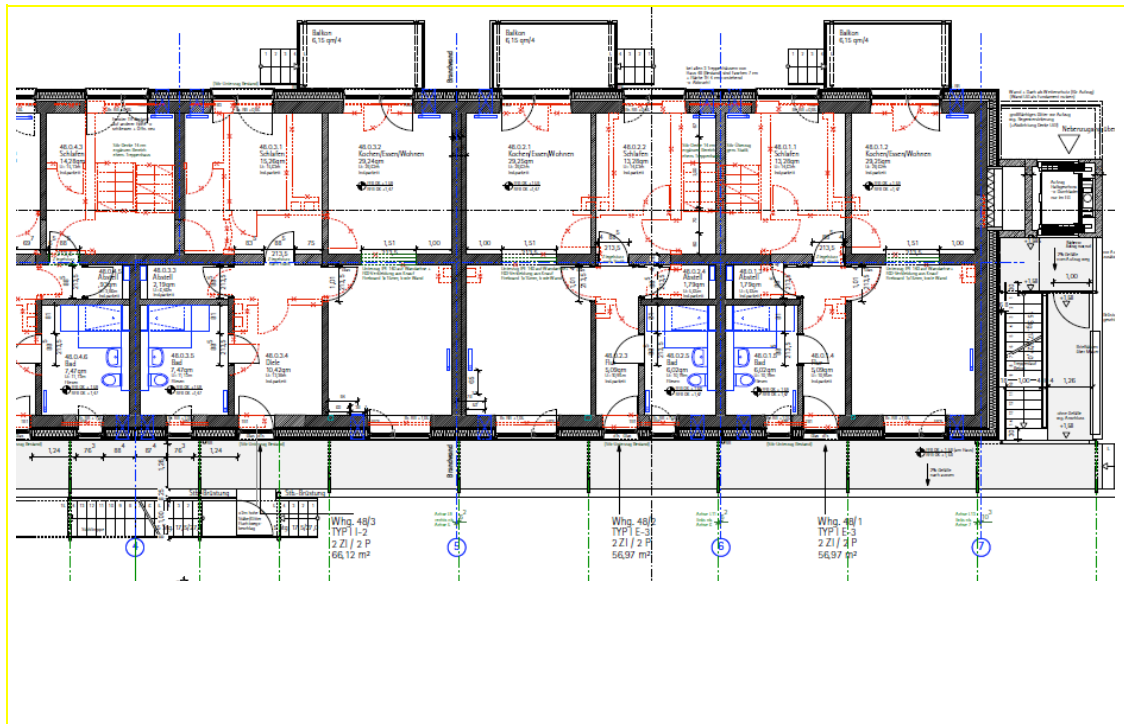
Wohnungsbau München Modernisierung Grundriss, Ausschnitt
